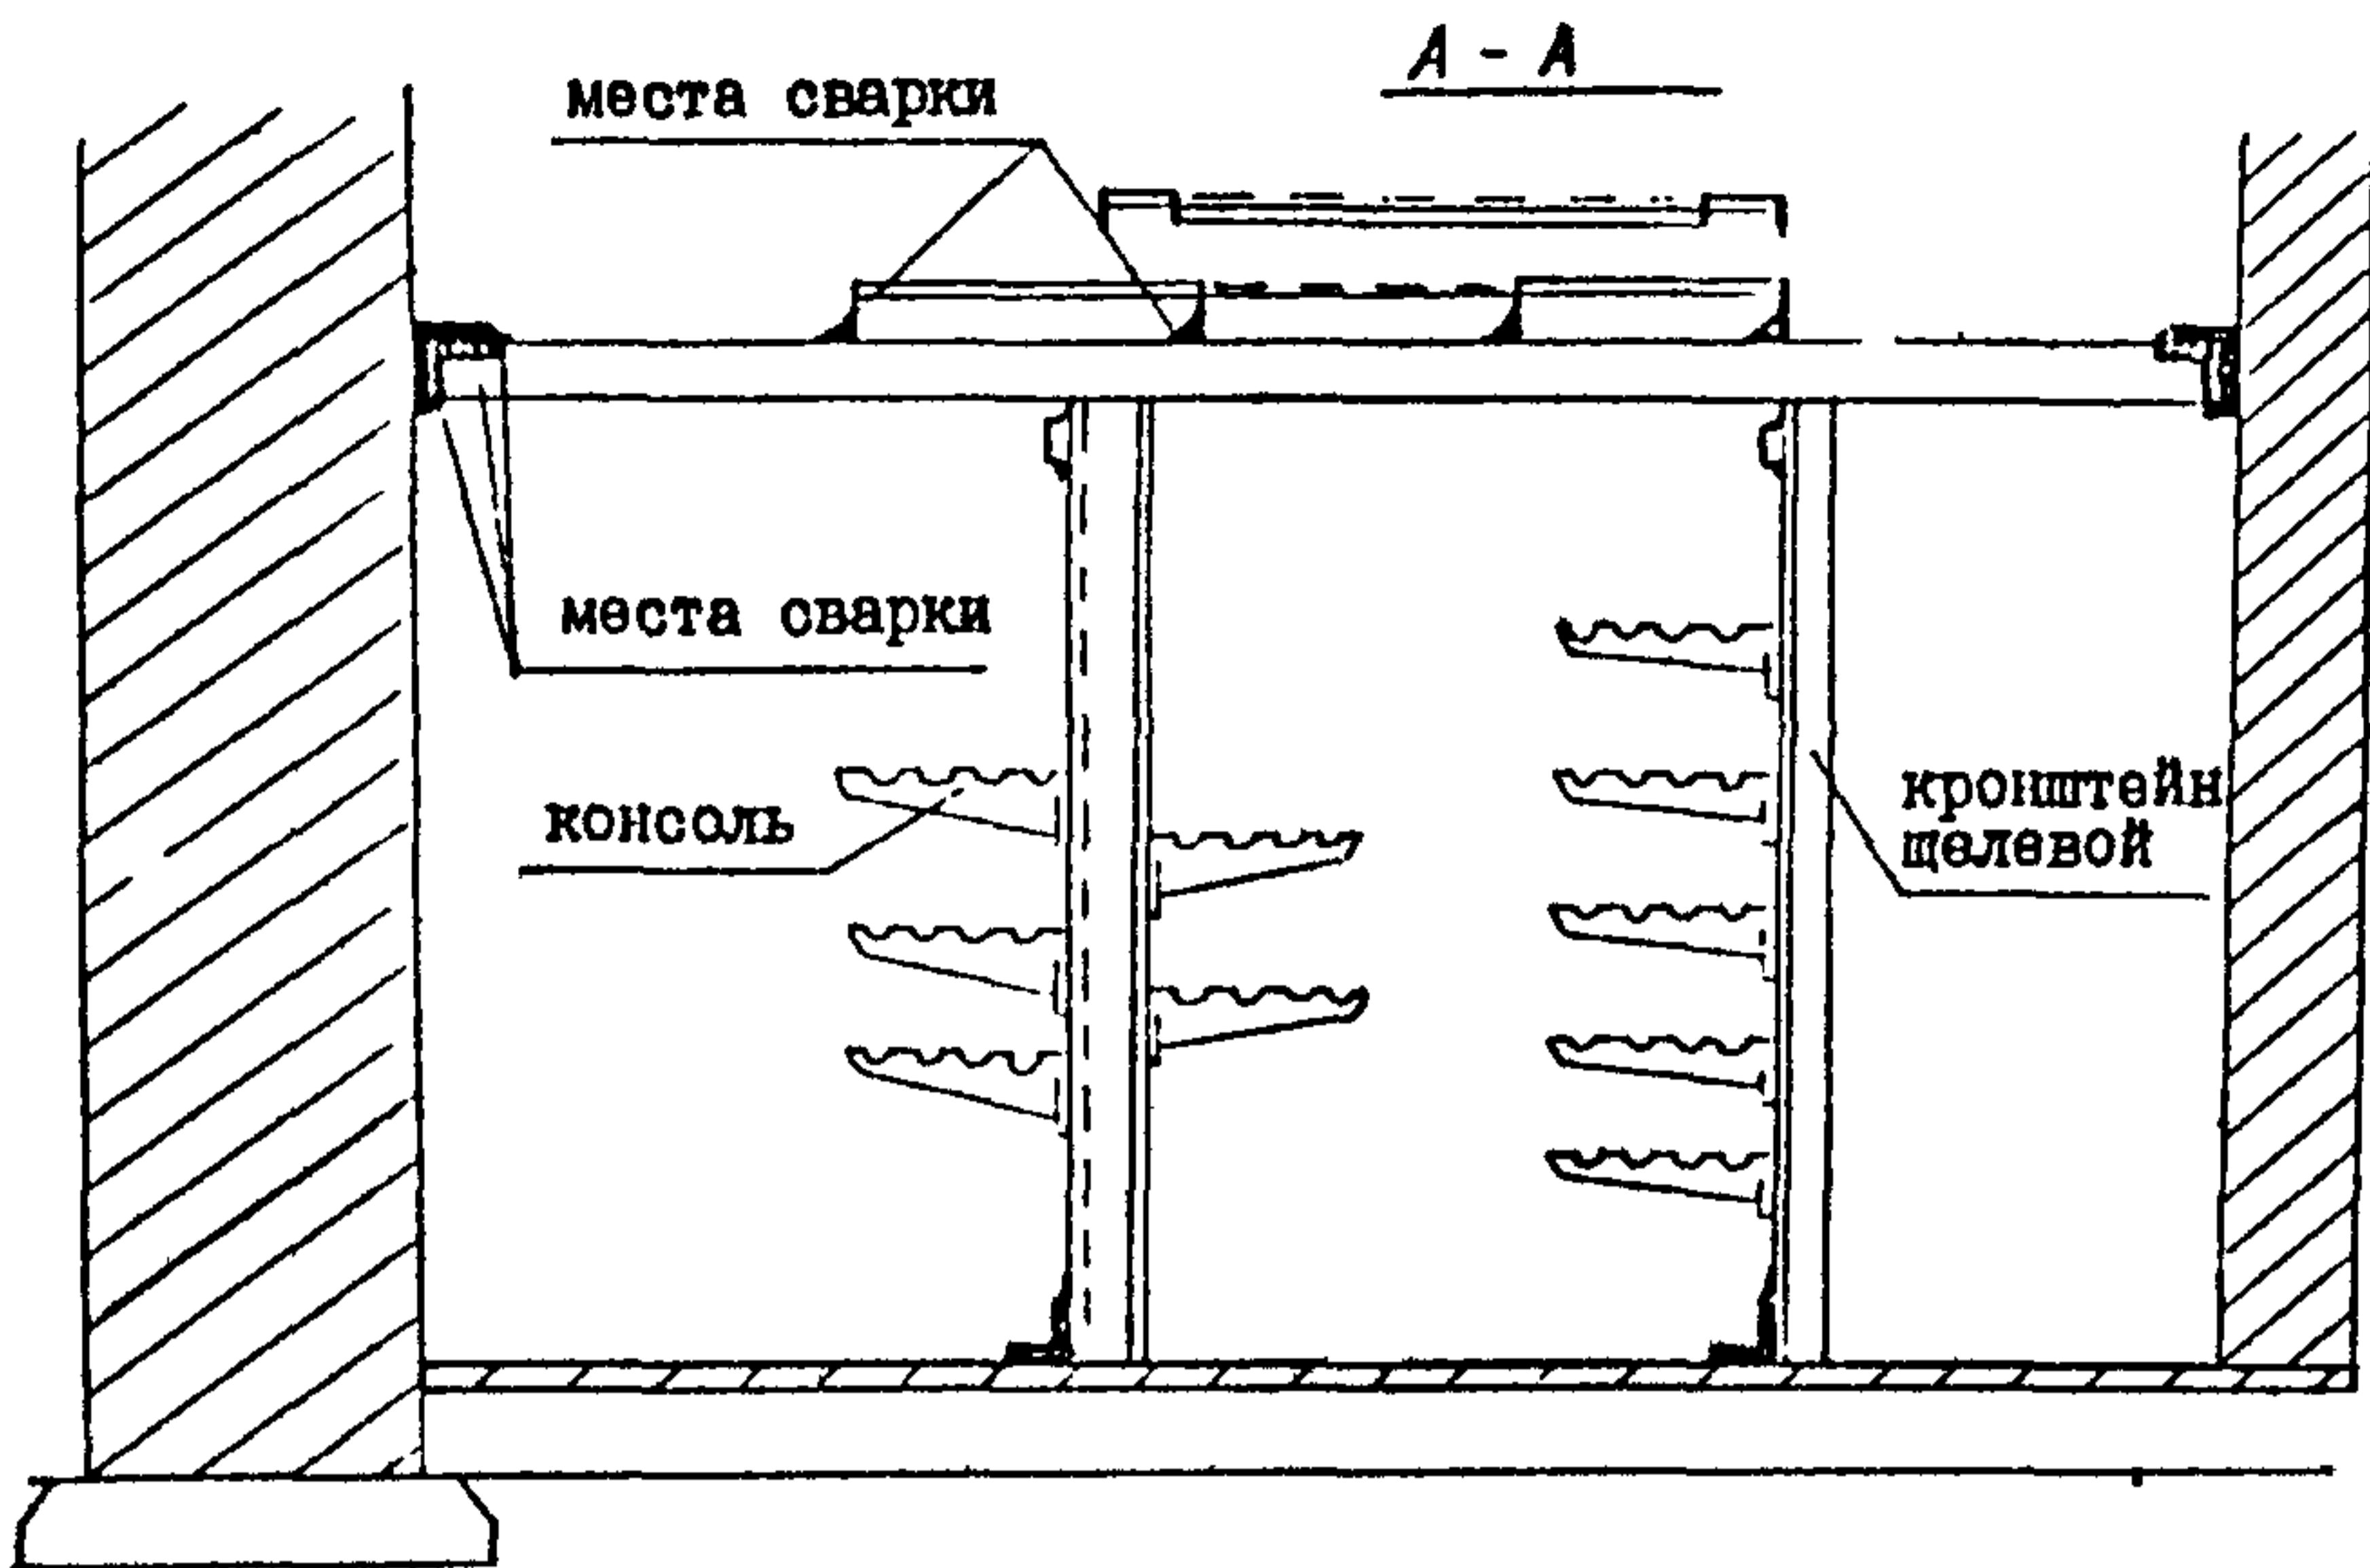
Расположение и места сварки желобов в шахте(примерное)
